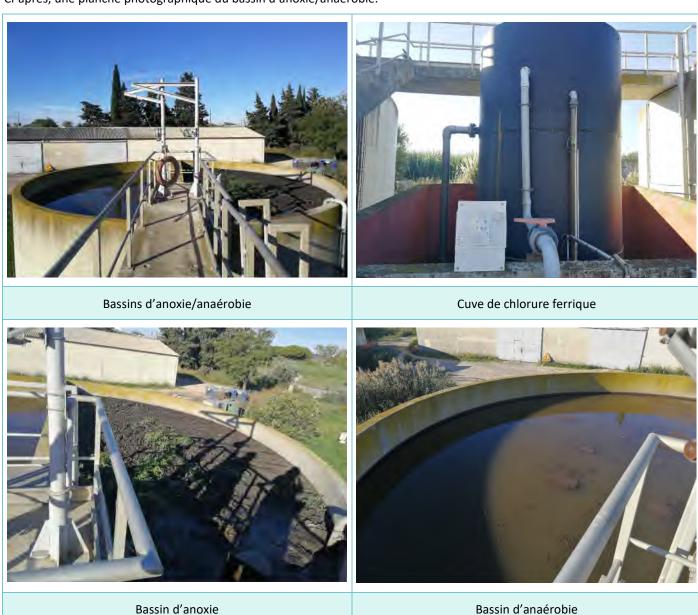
Planche photographique des bassins d'anoxie/anaérobie
